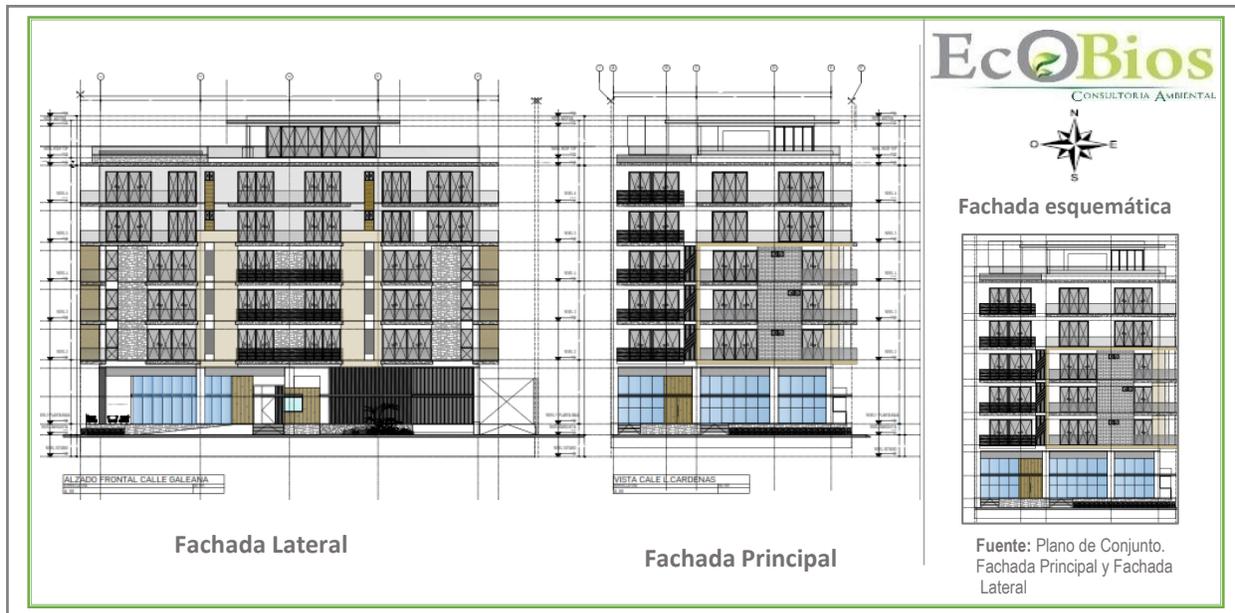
Detalle del diagrama del polígono Corte Fachada Principal y Fachada lateral
